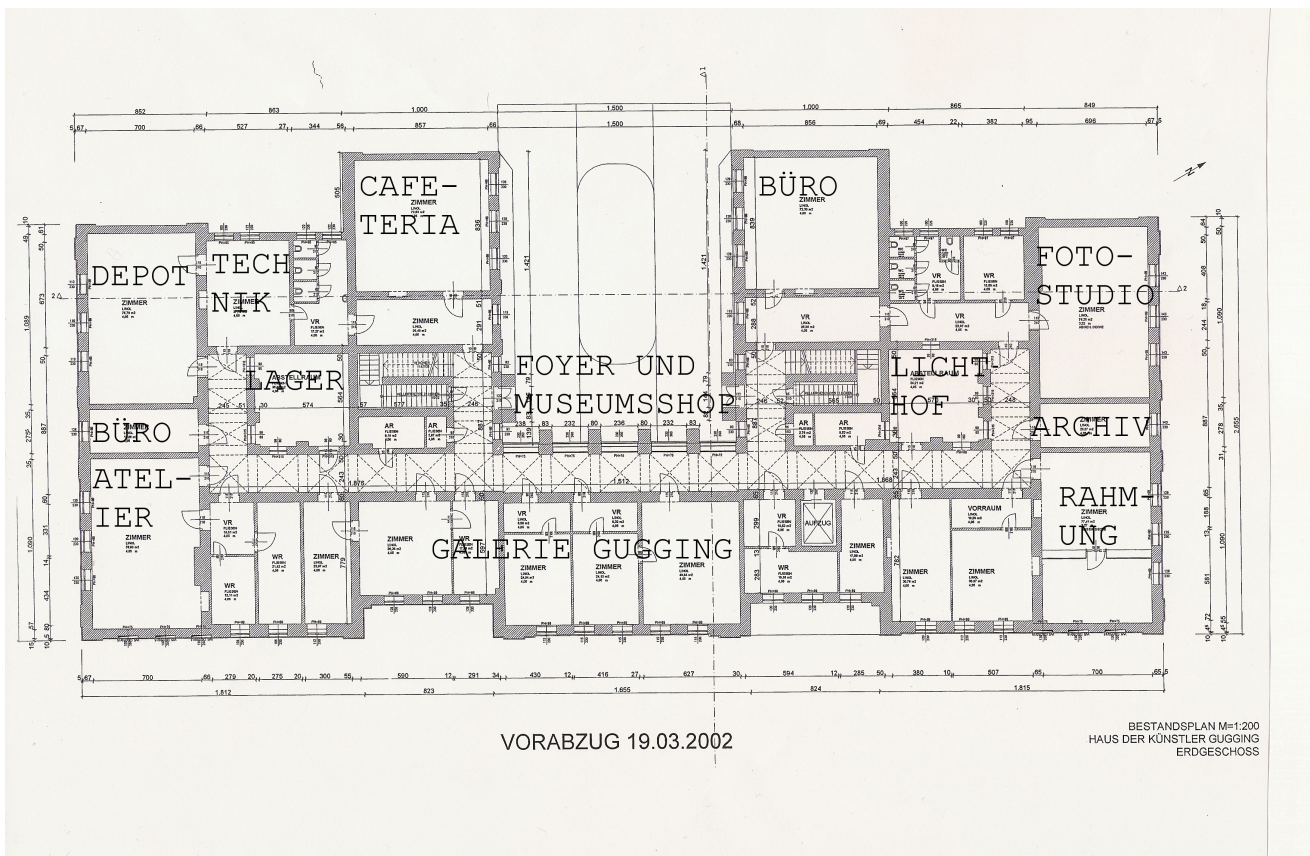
Grundriß Erdgeschoß des Art / Brut Center Gugging.
